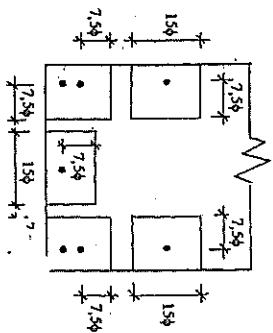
Área de concreto interessada pela fissuração
